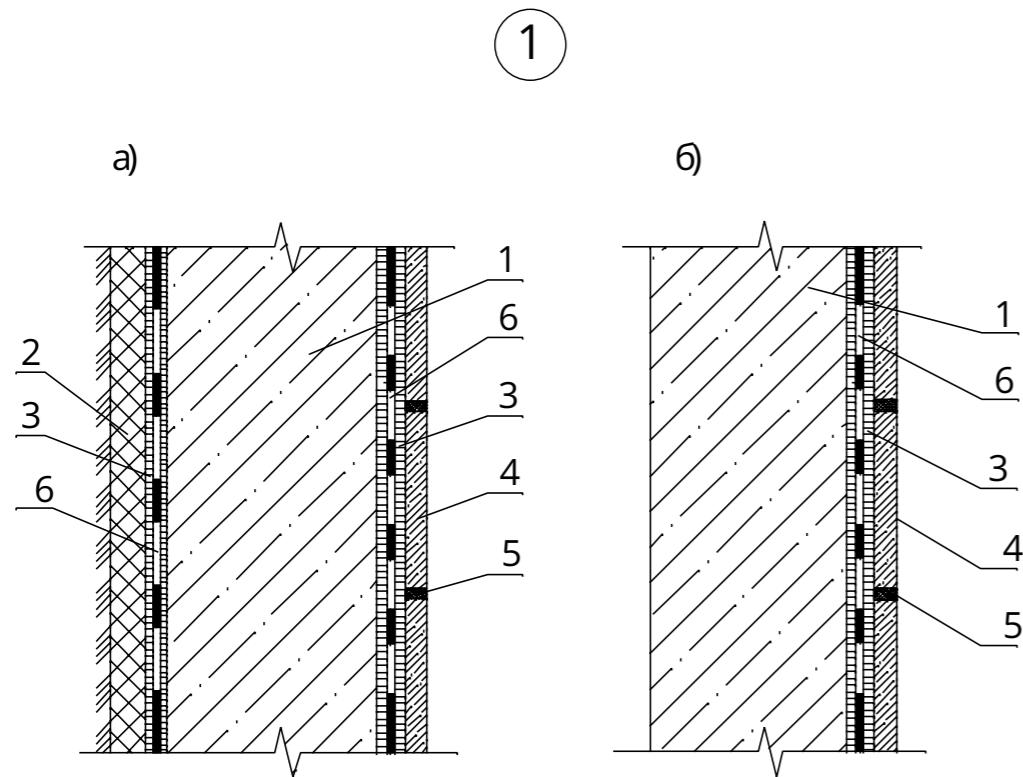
Узел 1. Стена чаши бассейна в грунте (а) и на перекрытии (б)
